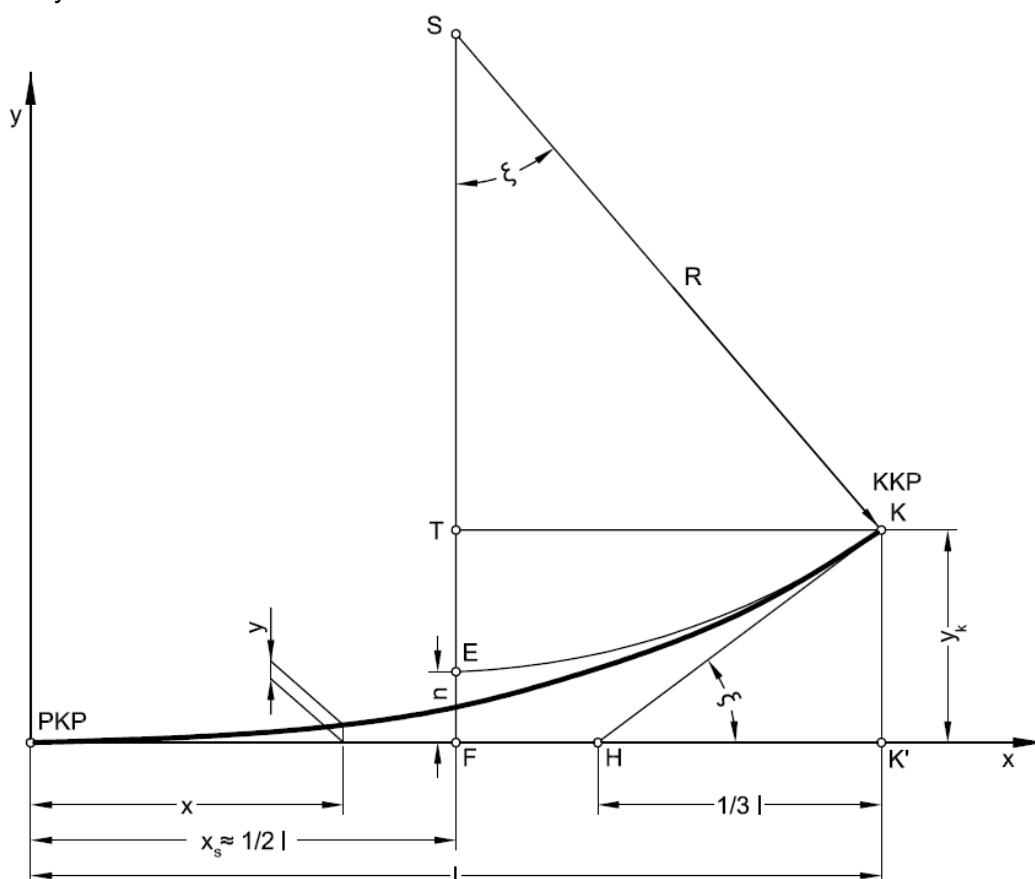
Krzywoliniowa rampa przechyłkowa
